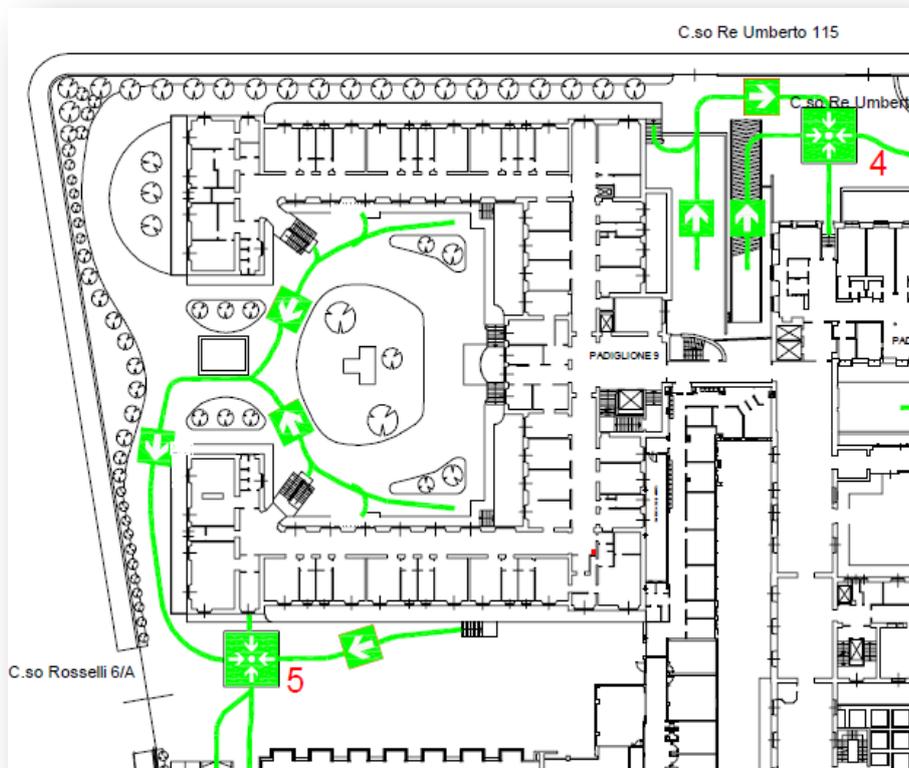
P.E.I. estratto della planimetria generale indicante punti di raccolta e vie di esodo
